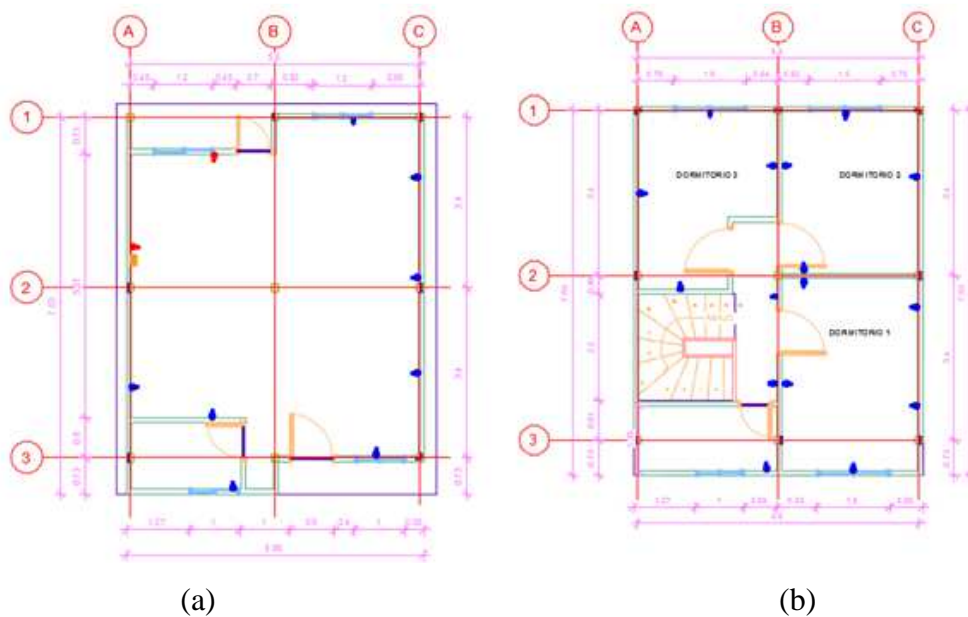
Distribución de tomacorrientes planta baja (a) y segunda planta (b)
